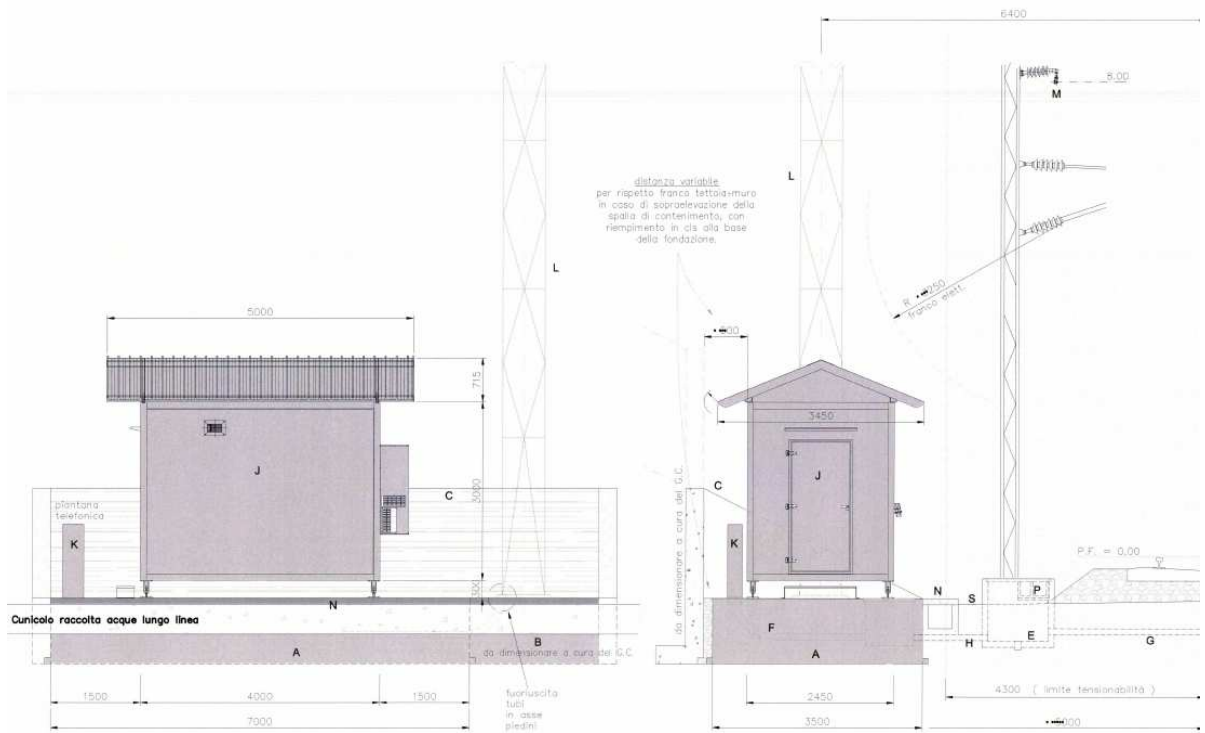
Piazzole BTS: sezioni trasversale e longitudinale
